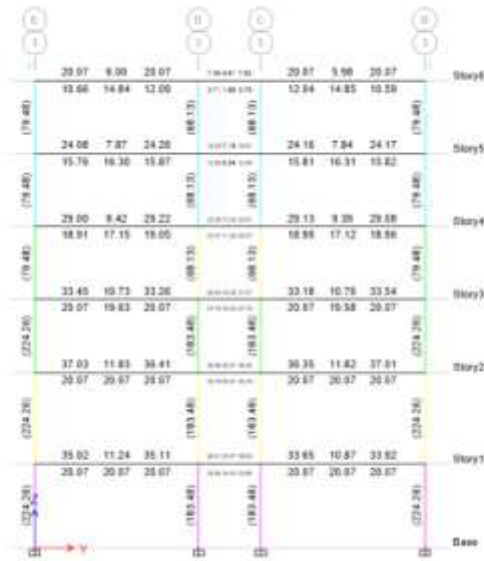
REFUERZO LONGITUDINAL EJE 4
